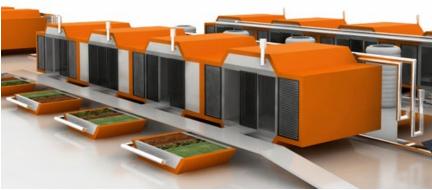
Construcción en prefabrica modular, FUENTE: http://www.quetipos.com/portfolio/vivienda-prefabricada-en-madera/
